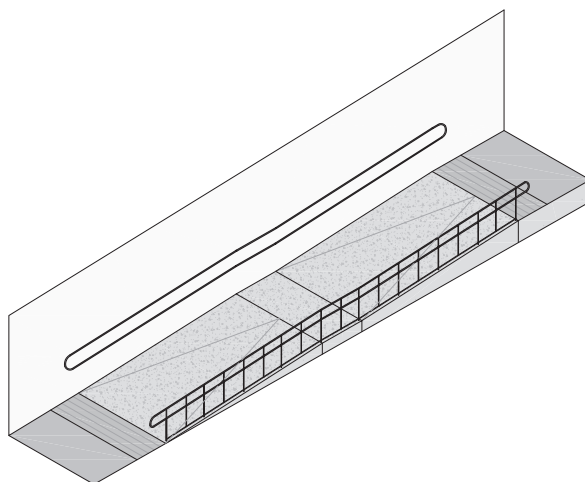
Planta y sección de una rampa con descanso intermedio.
